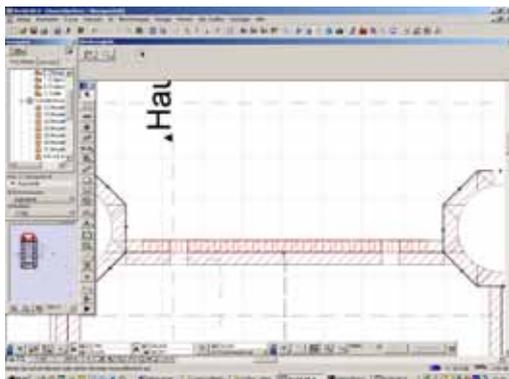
Bibliothekselement im Grundriss
